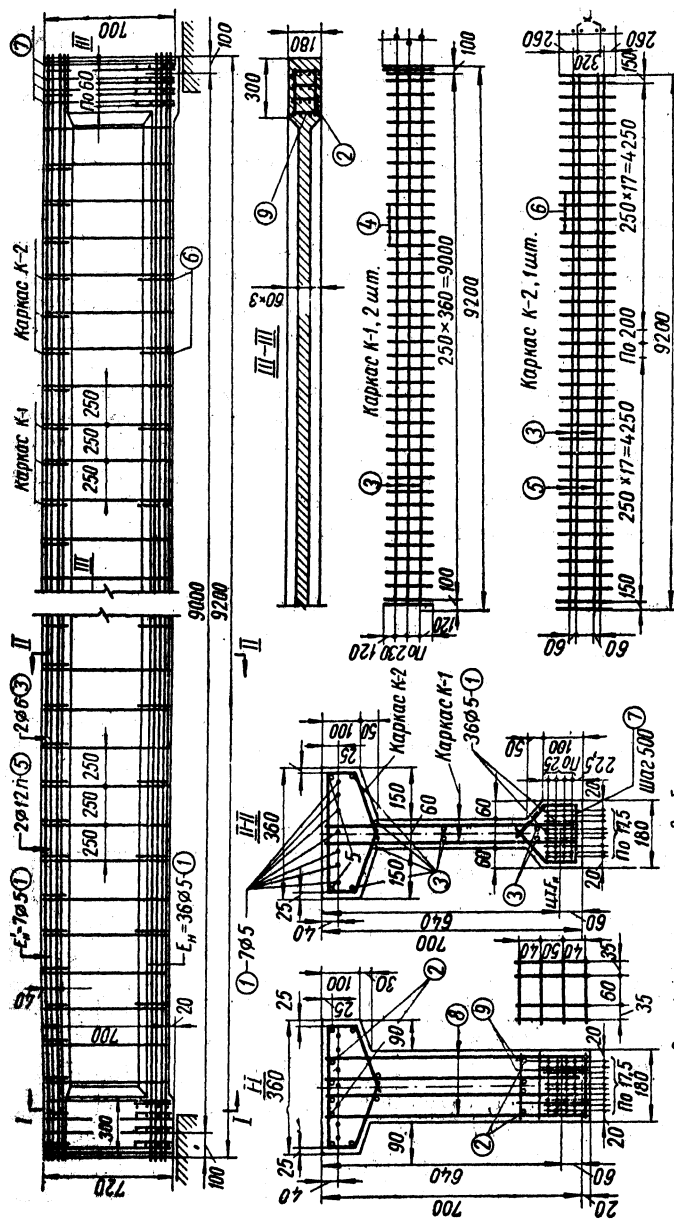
К расчету железобетонной предварительно напряженной балки:
